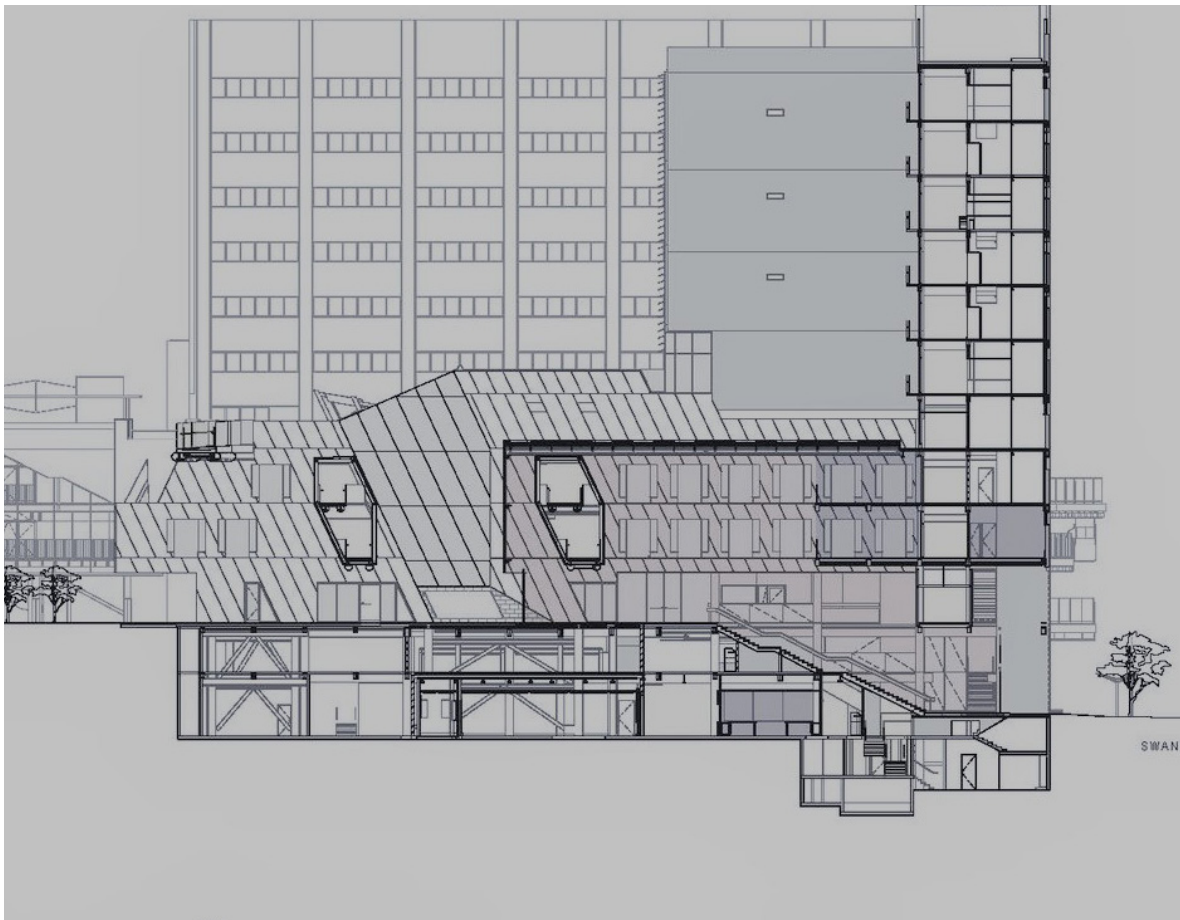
RMTI New Academic street / Lyons, corte longitudinal.
